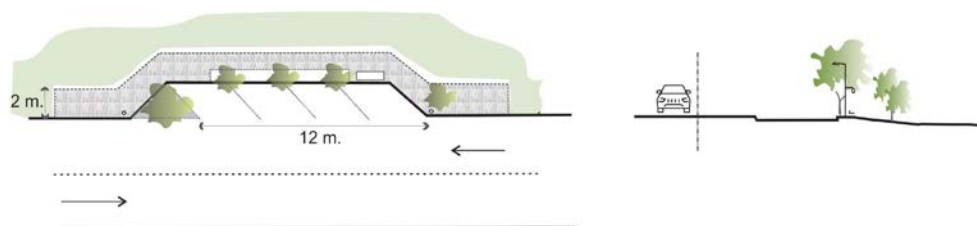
Esquema de ensanche y veredas. Elaboración propia
